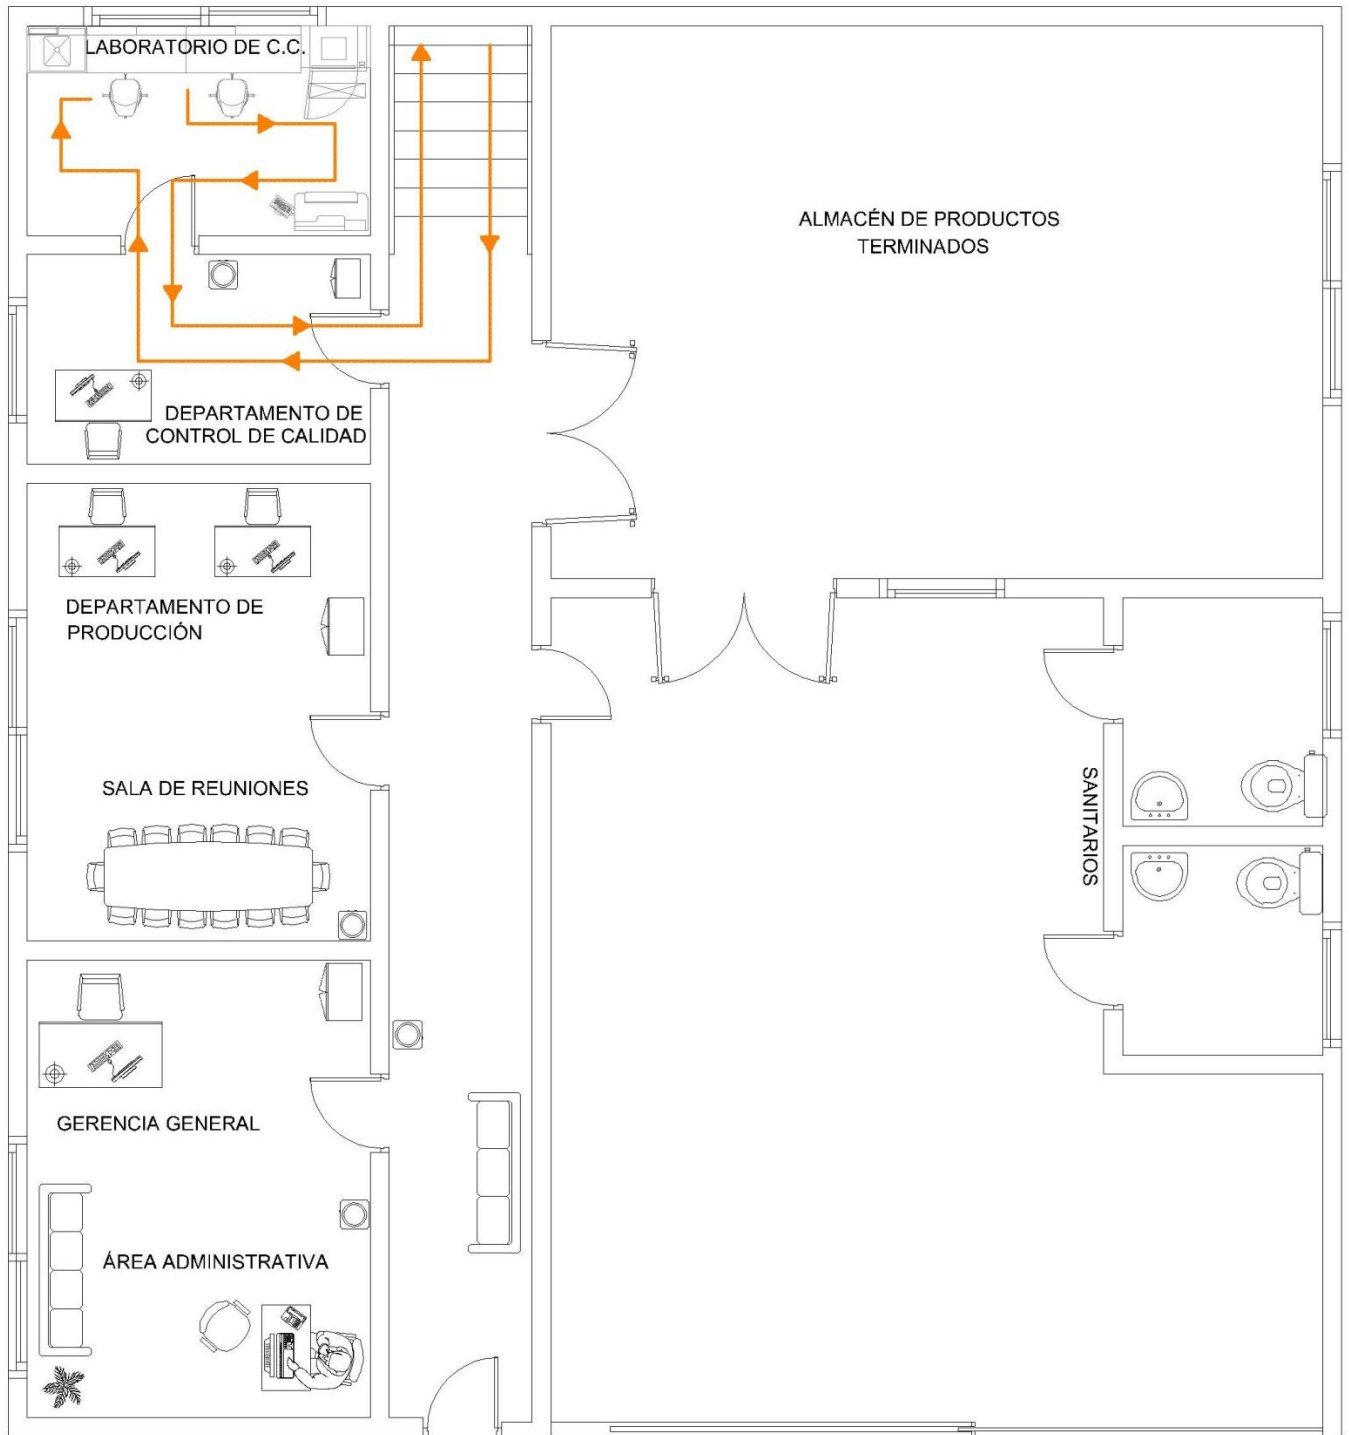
Plano: Recorrido en planta baja del encargado/supervisor del laboratorio de control de calidad.
